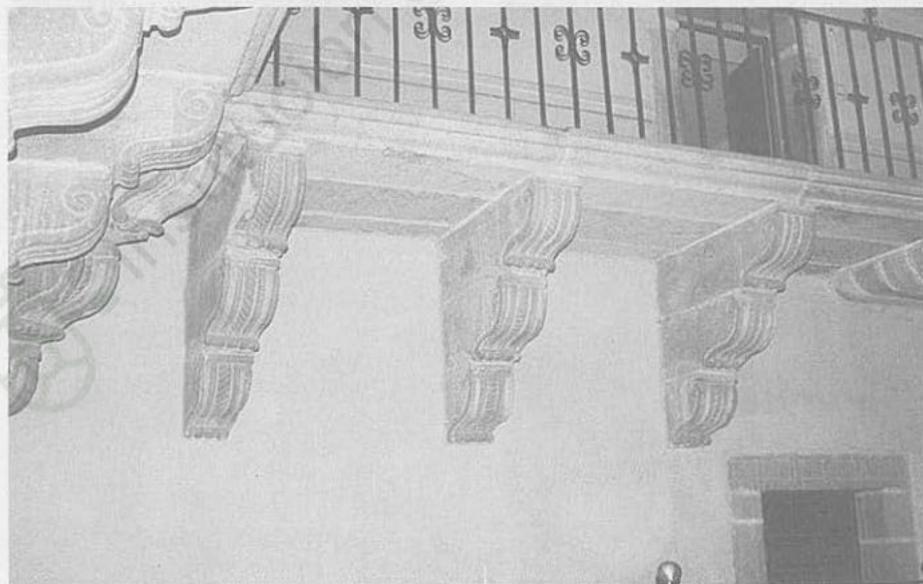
Claustro del Silencio. Panda este. Escalera de los Papas. Tramo 9.
